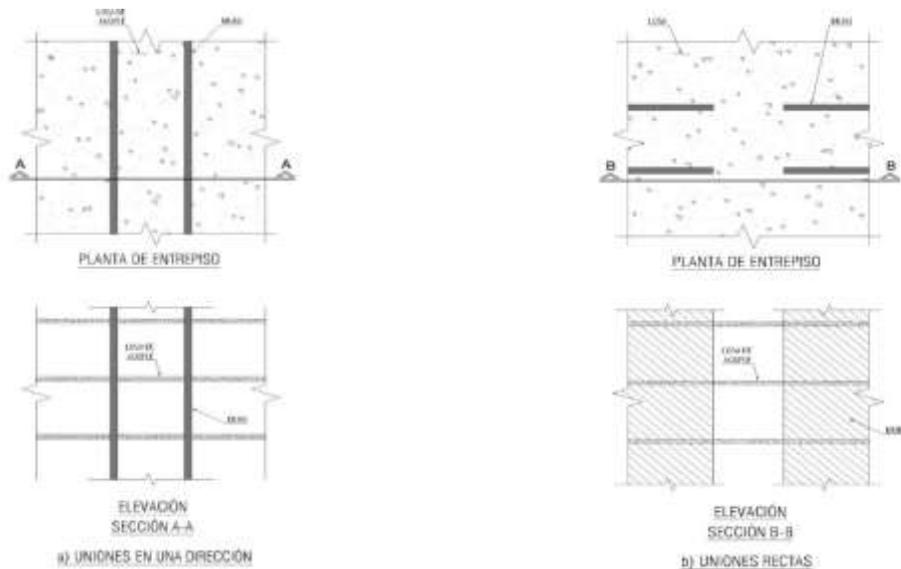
Ilustración de los tipos de unión losa-muro.
